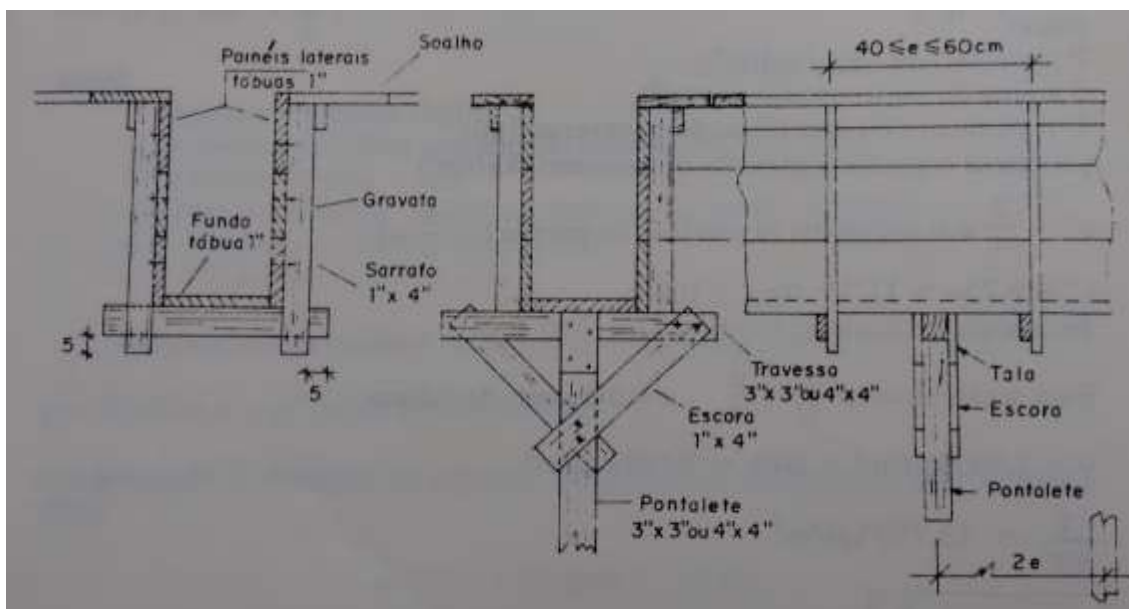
Detalhamento de fôrmas de madeira serrada para vigas com dois panos de laje maciça.
